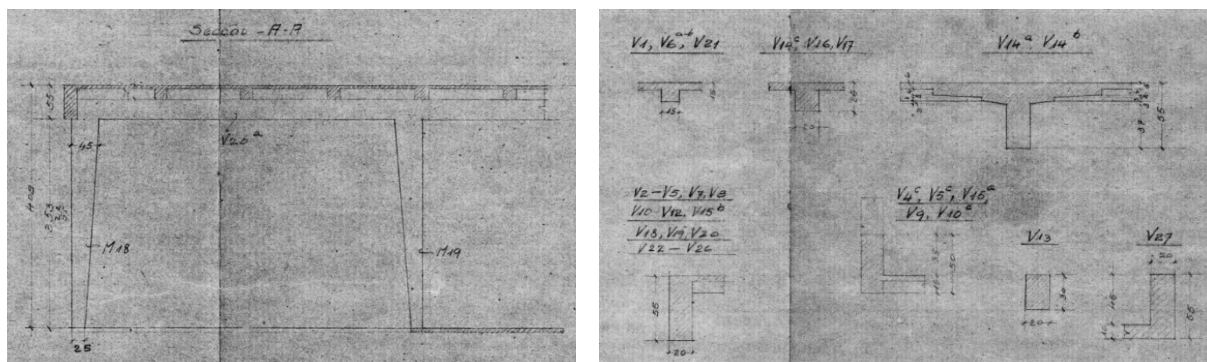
Vão da administração mostrando a variação nos elementos estruturais. Viga corrida com variedade formal, pilares principais com diminuição de base e grelha da recepção como ambiente adjacente.
